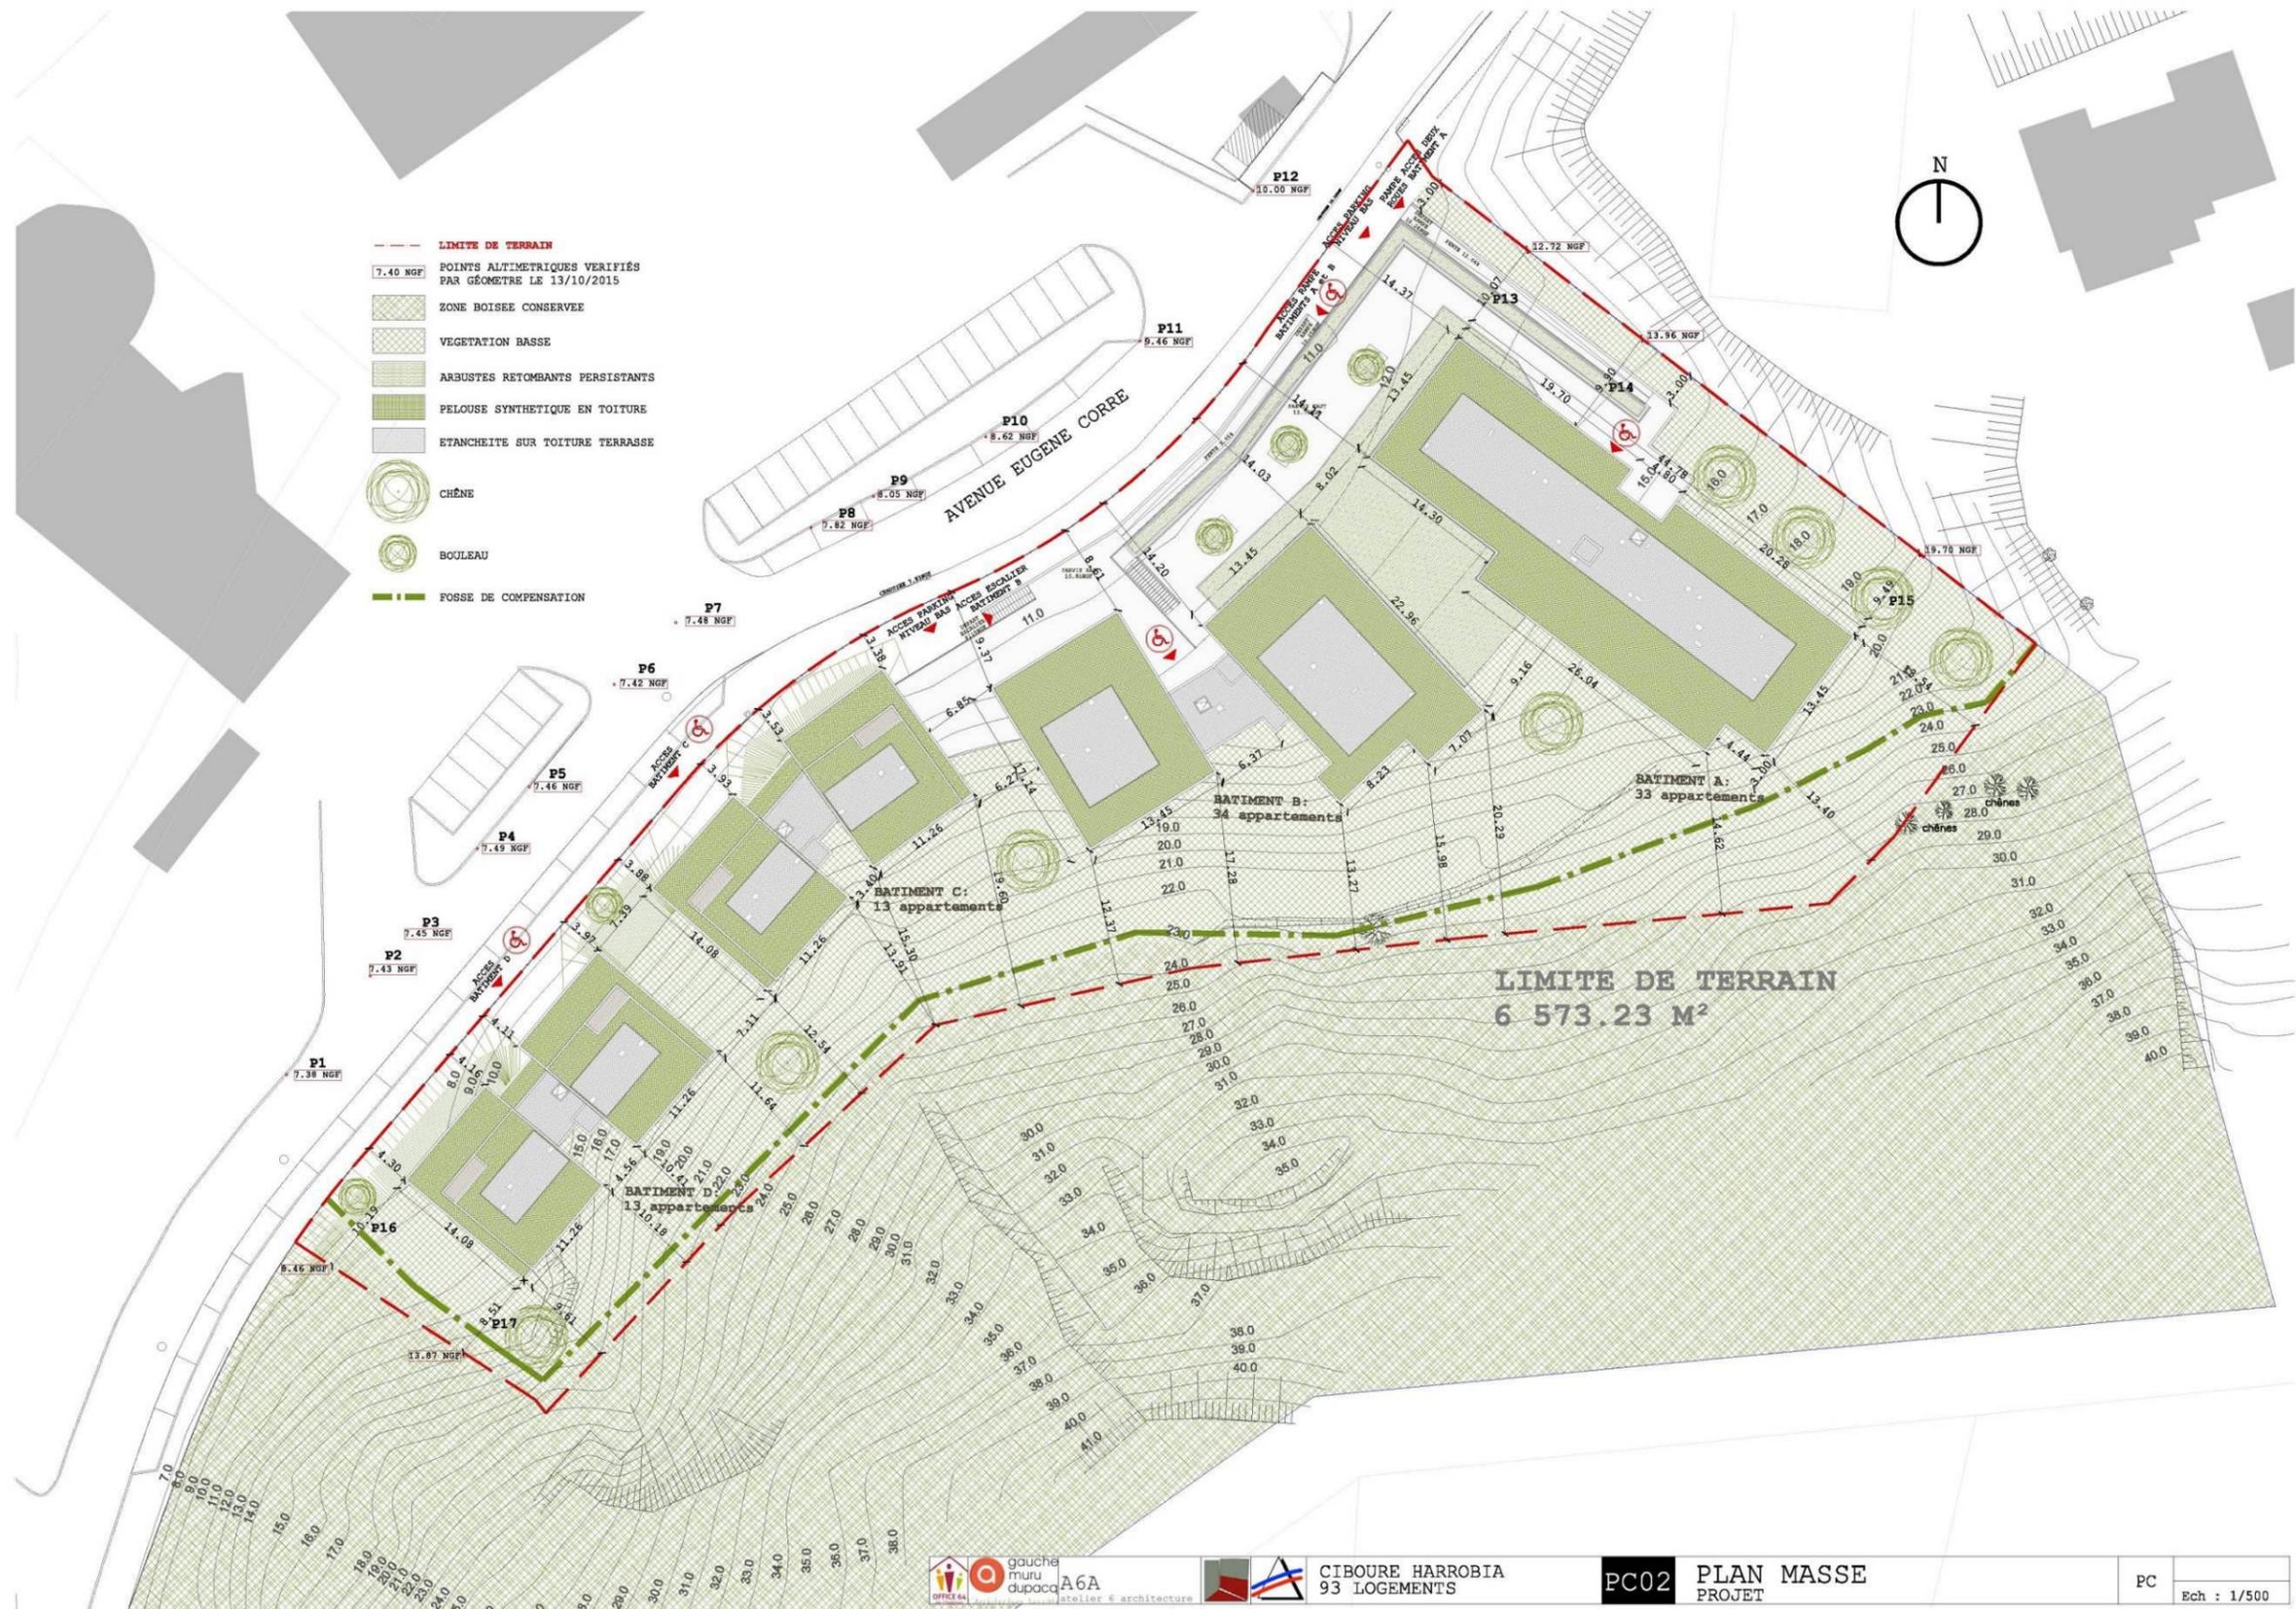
plan de masse du projet (source: architecte Gauche Muru Dupacq)
